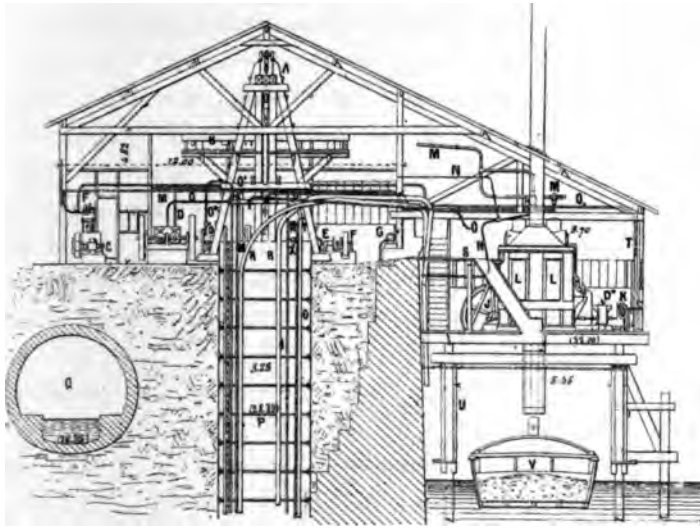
Coupe transversale du chantier sur ABCD du plan.
